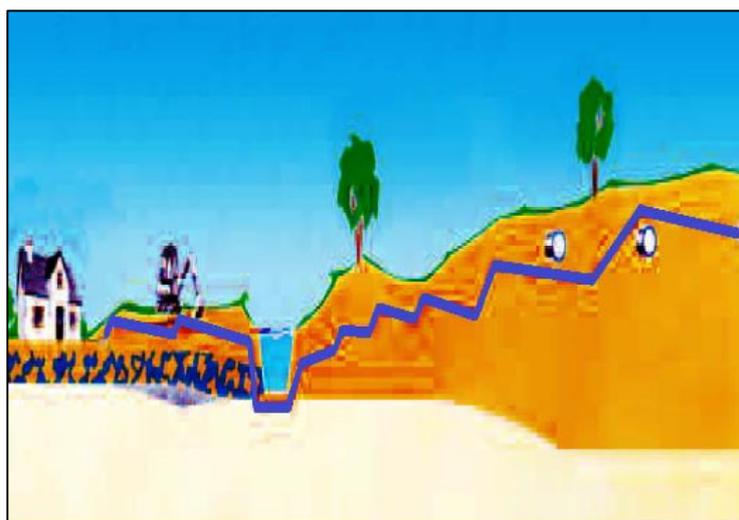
perfil de alcantarillado por vacío. Fuente: Terraigua
